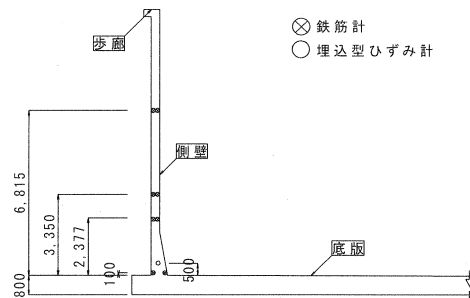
鉄筋計および埋込型ひずみ計埋設位置 (単位: mm)
